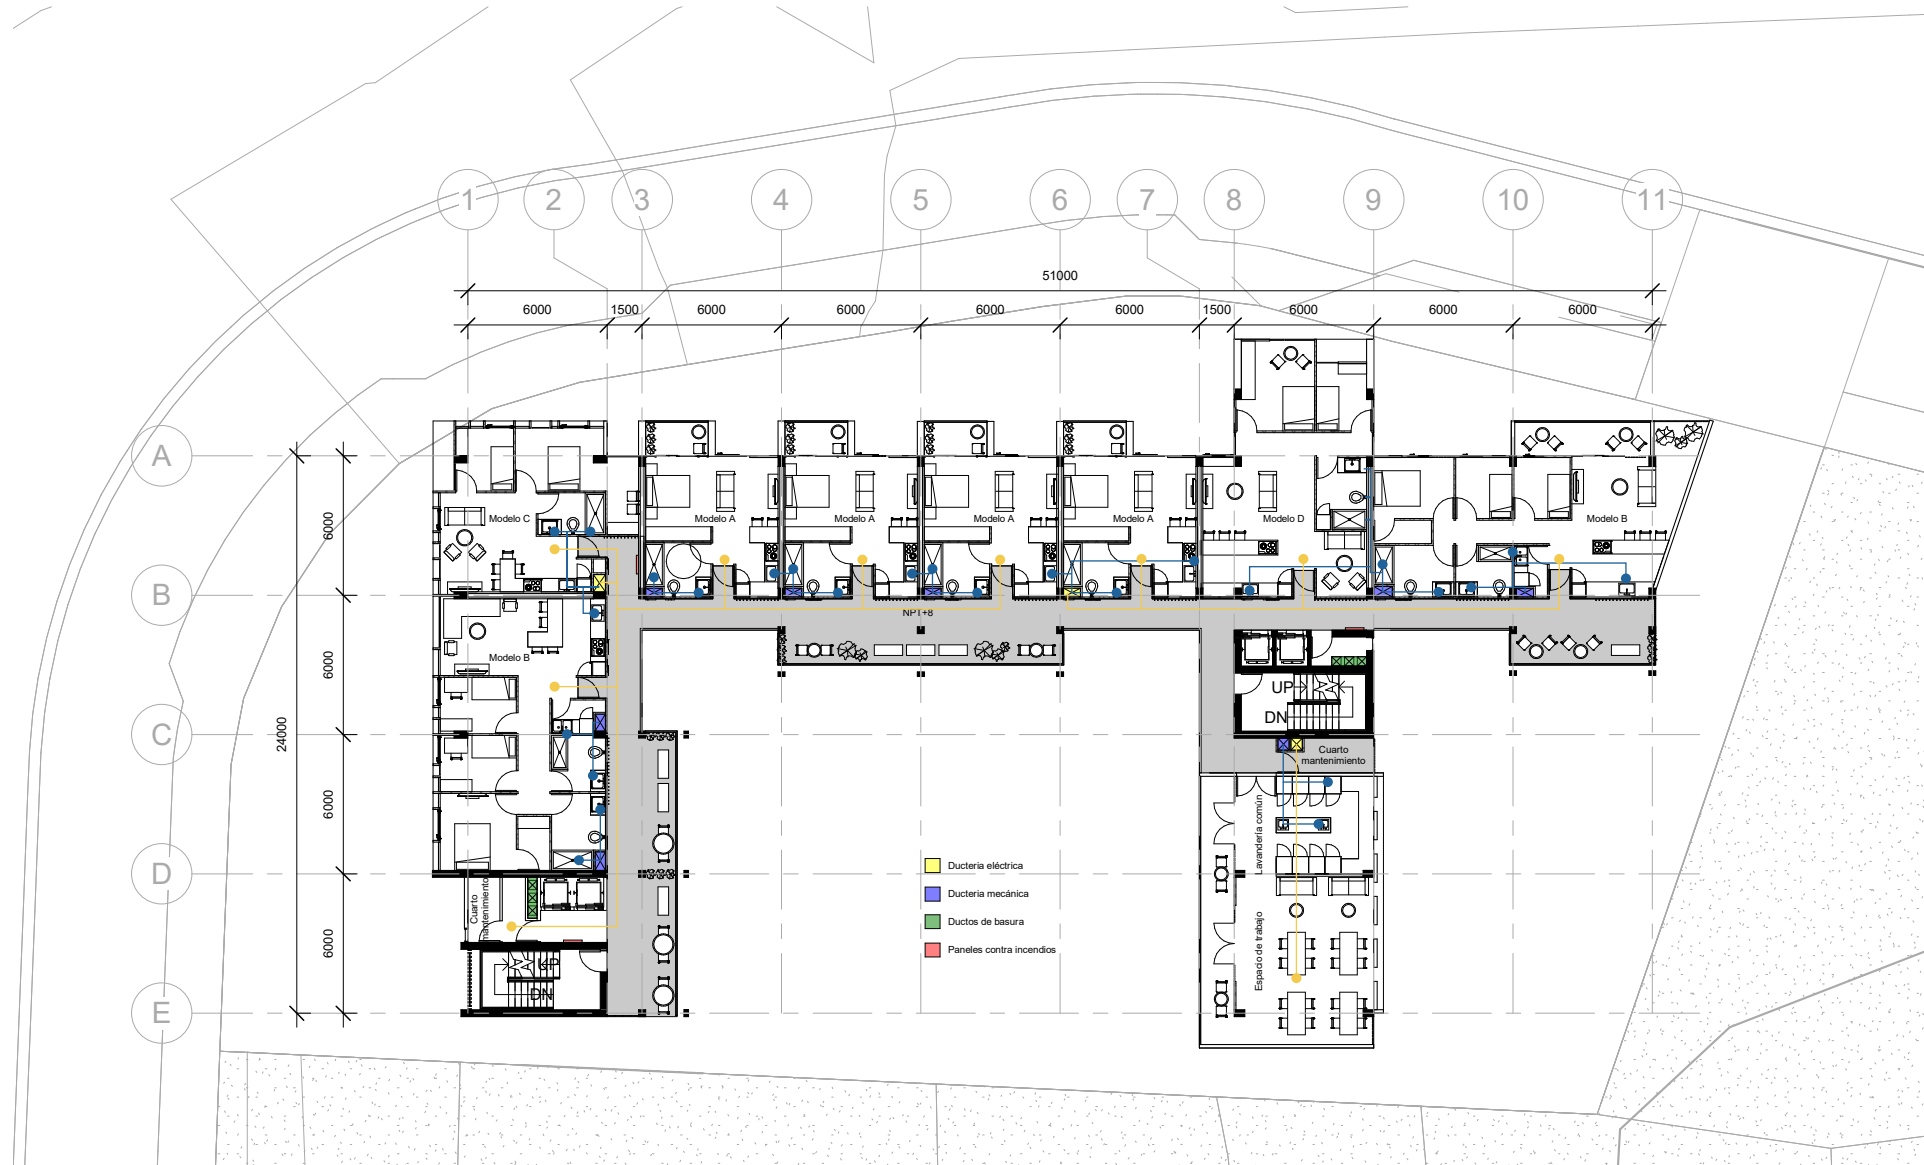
Planta nivel 2. Fuente: Elaboración propia.
